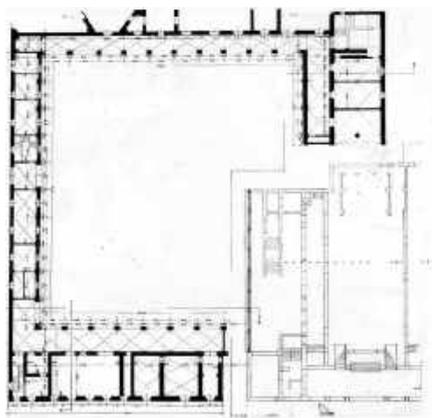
Chiostro, pianta piano terra, prima dei lavori di restauro
